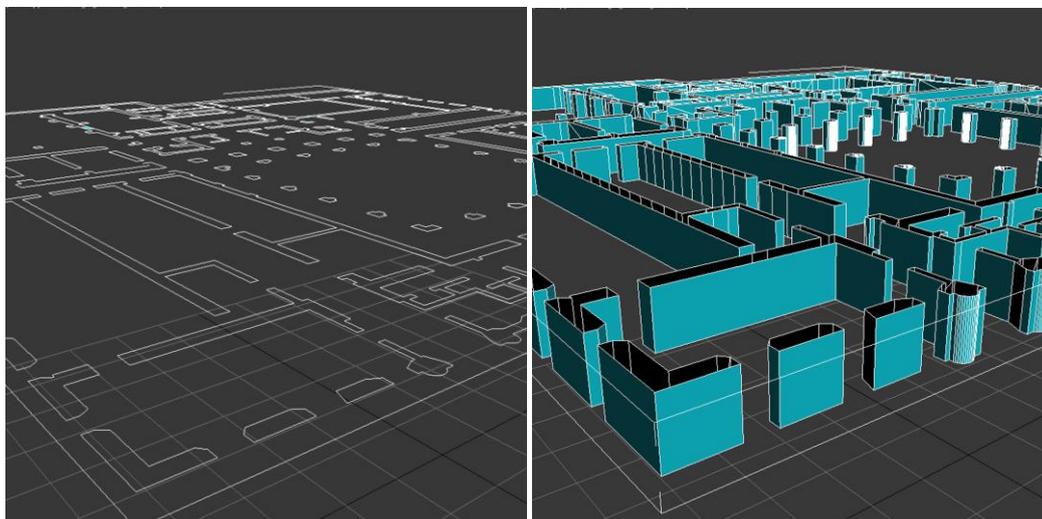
Vista de las líneas del plano dentro del modelador y su respectiva extrusión.
